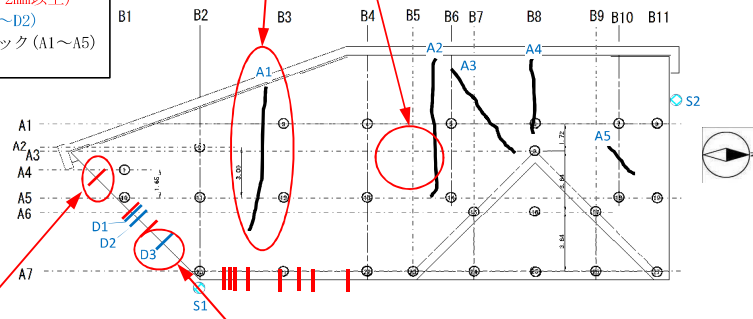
搬出入施設・車両乗降部 平面図 (上部工)
